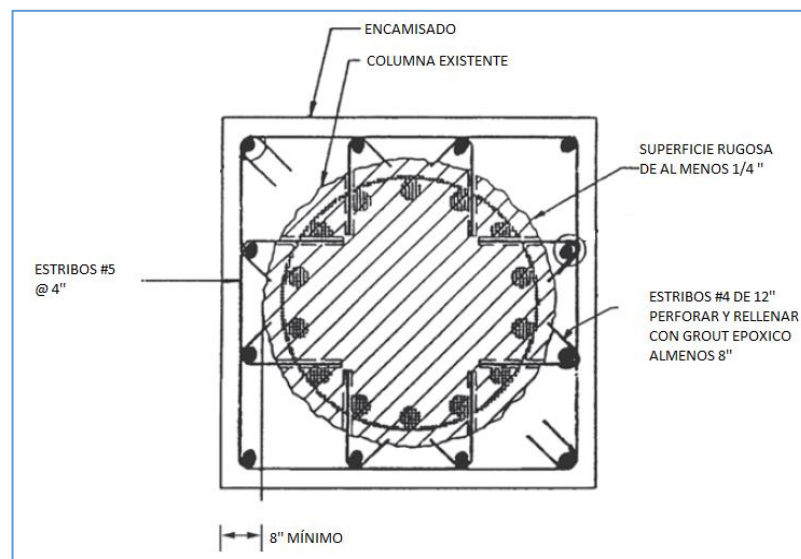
Detalle y recomendaciones para encamisados en columnas circulares
